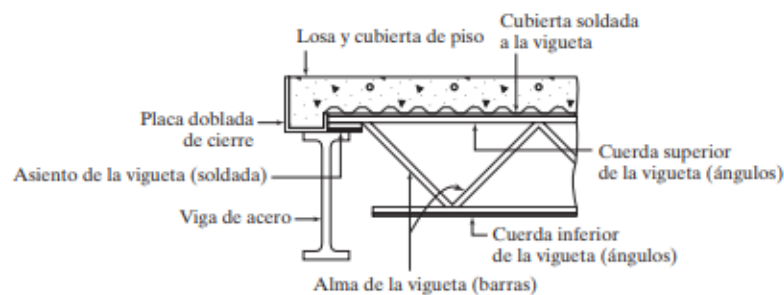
Losas de concreto sobre vigas de acero de alma abierta (McCormac & Csernak, 2013, pág. 648)
